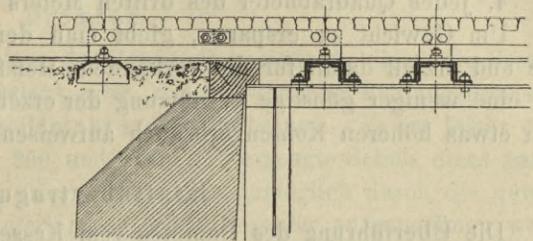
Doppelstühle für die Zahnstange auf eisernen Brücken.
